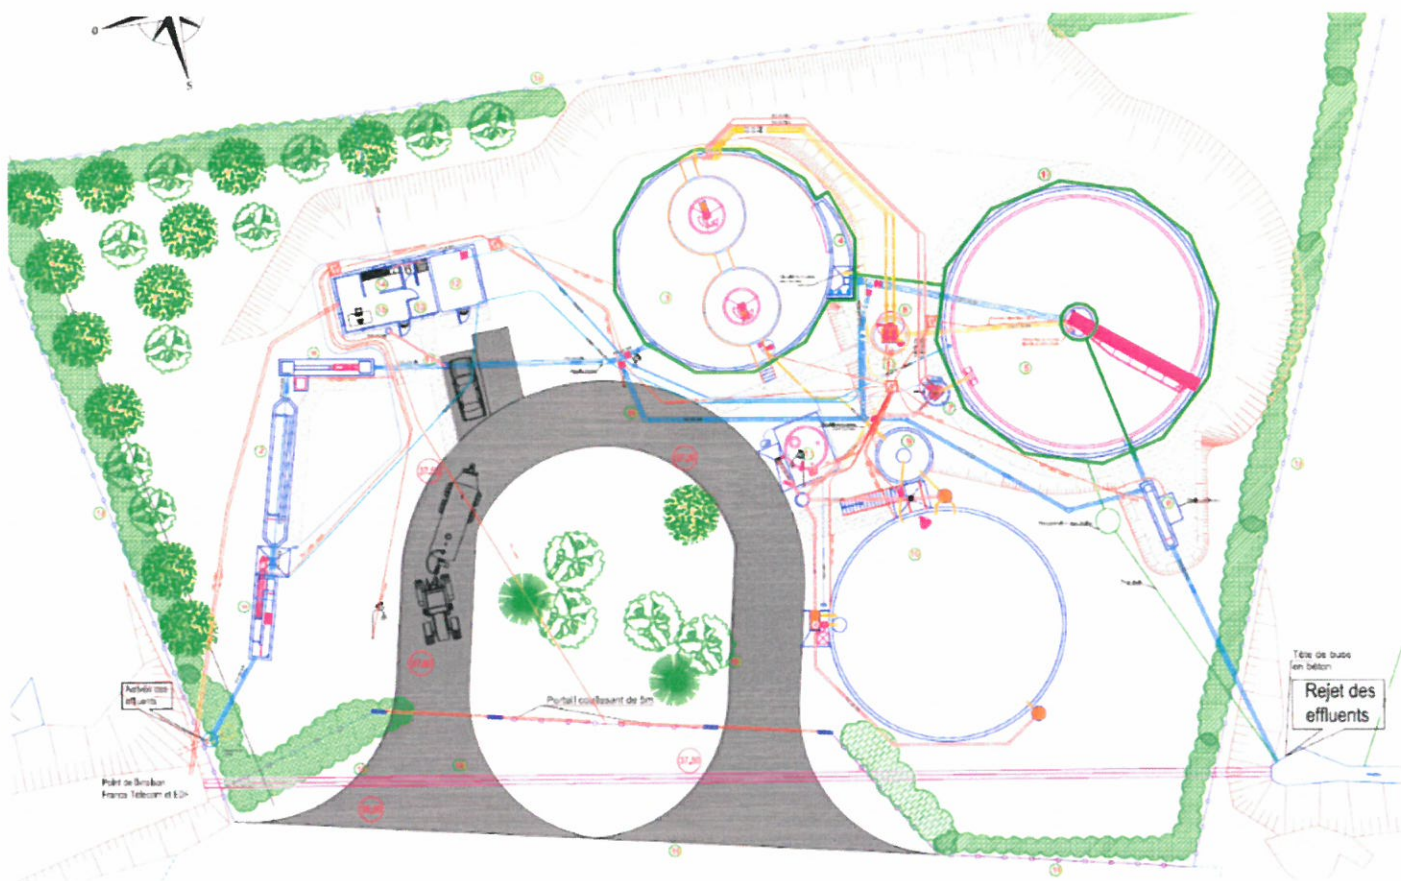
Plan des ouvrages et réseaux de la station d'épuration (Source Cegelec-Recolement)
